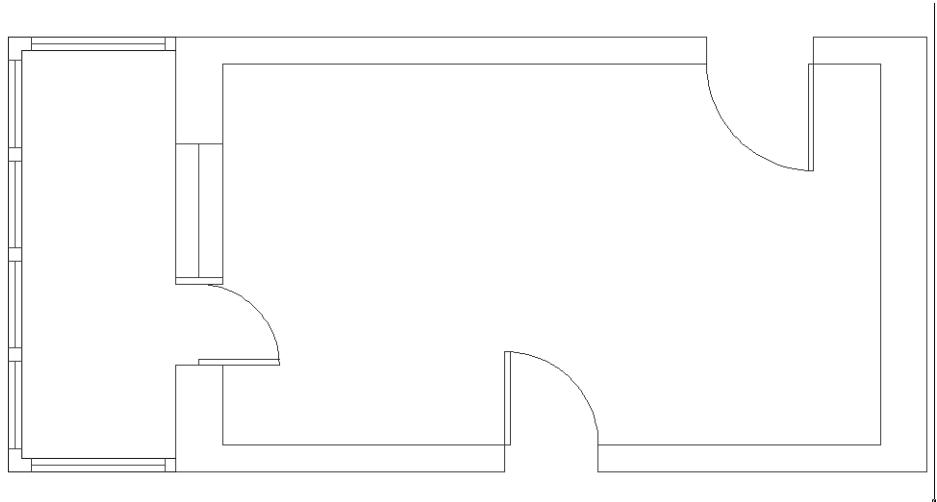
▼ Главный чертеж, представляющий собой план детской комнаты, готов для вставки внешней ссылки
